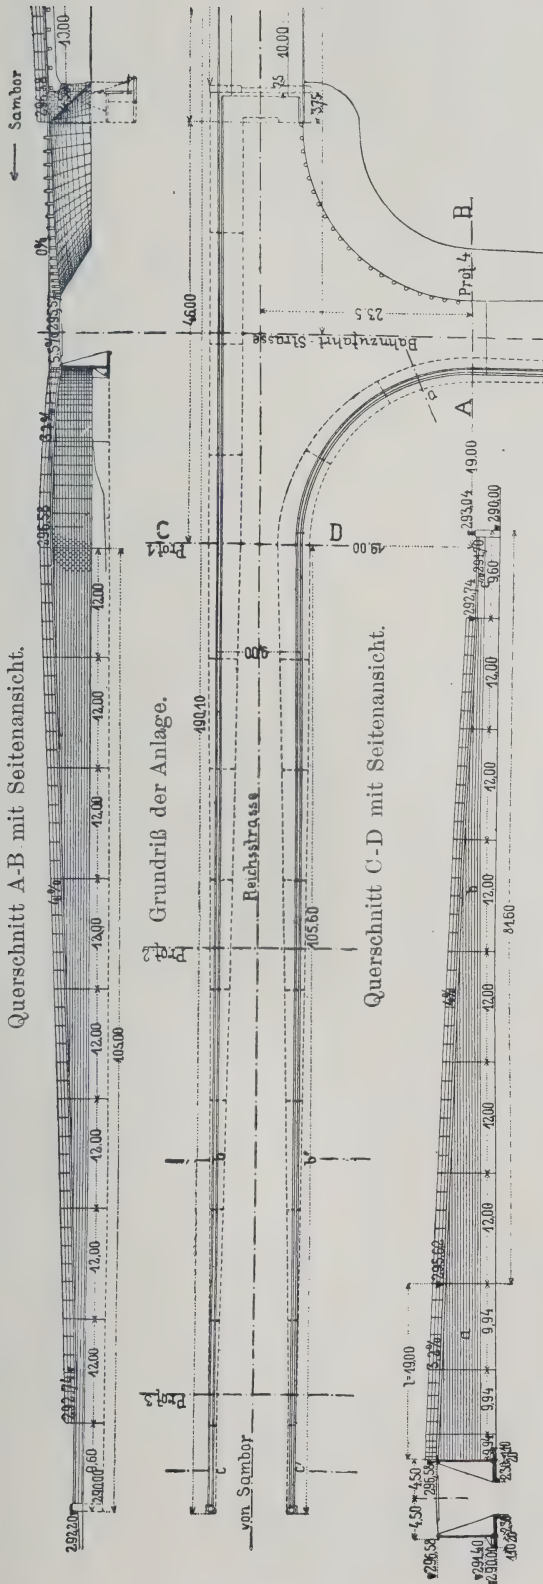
Grundriß und Ansichten der Stützmauer zu Sambor.
